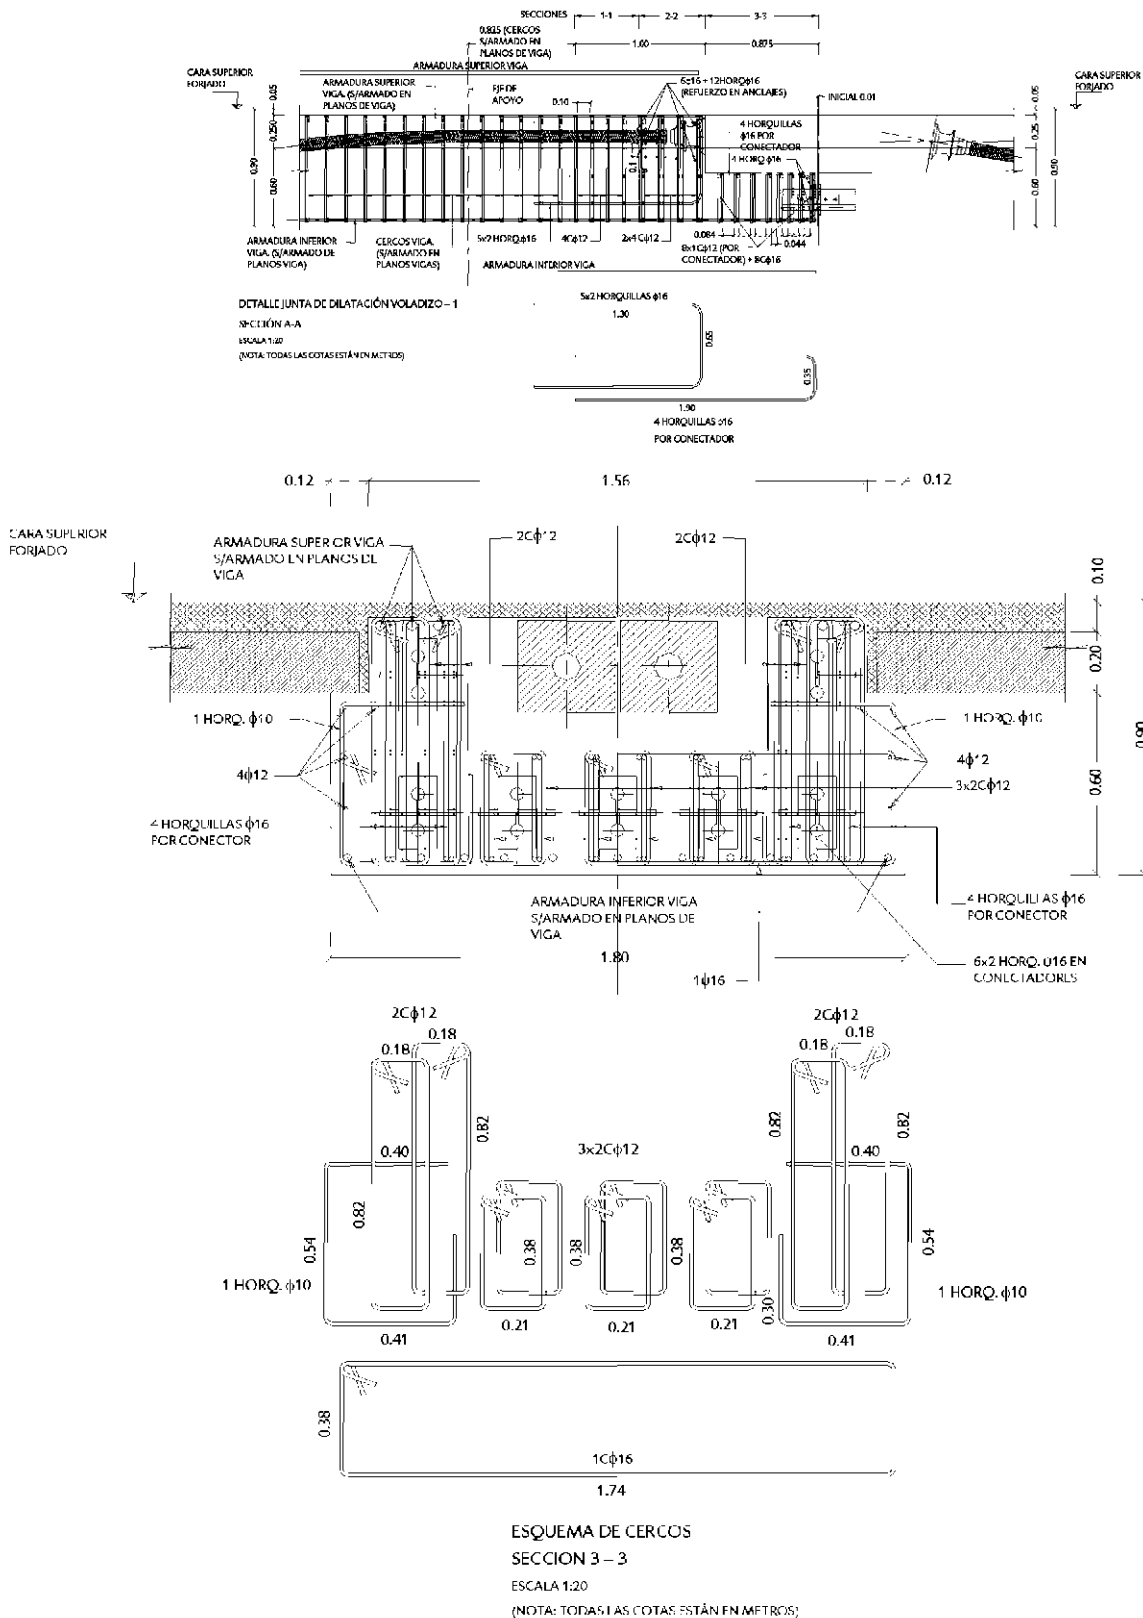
Detalle de la zona de la junta, definición geométrica, armadura pasiva, activa y conectadores.
